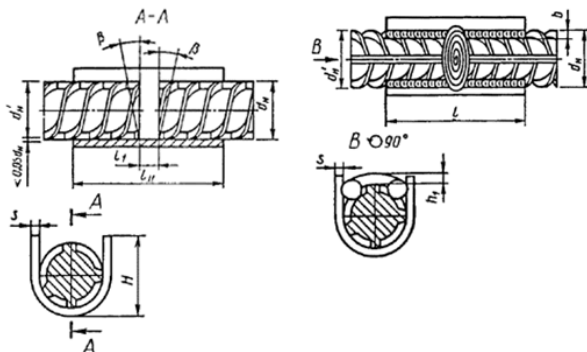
Ванношовная сварка арматурных стержней на стальной скобе-накладке
